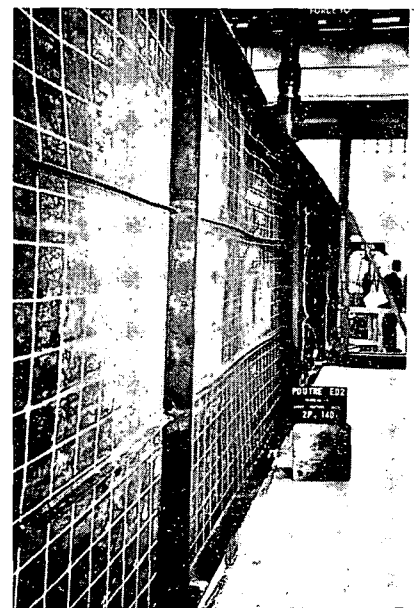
Vue de détail de l'âme d'une poutre métallique après sa rupture par voilement.
